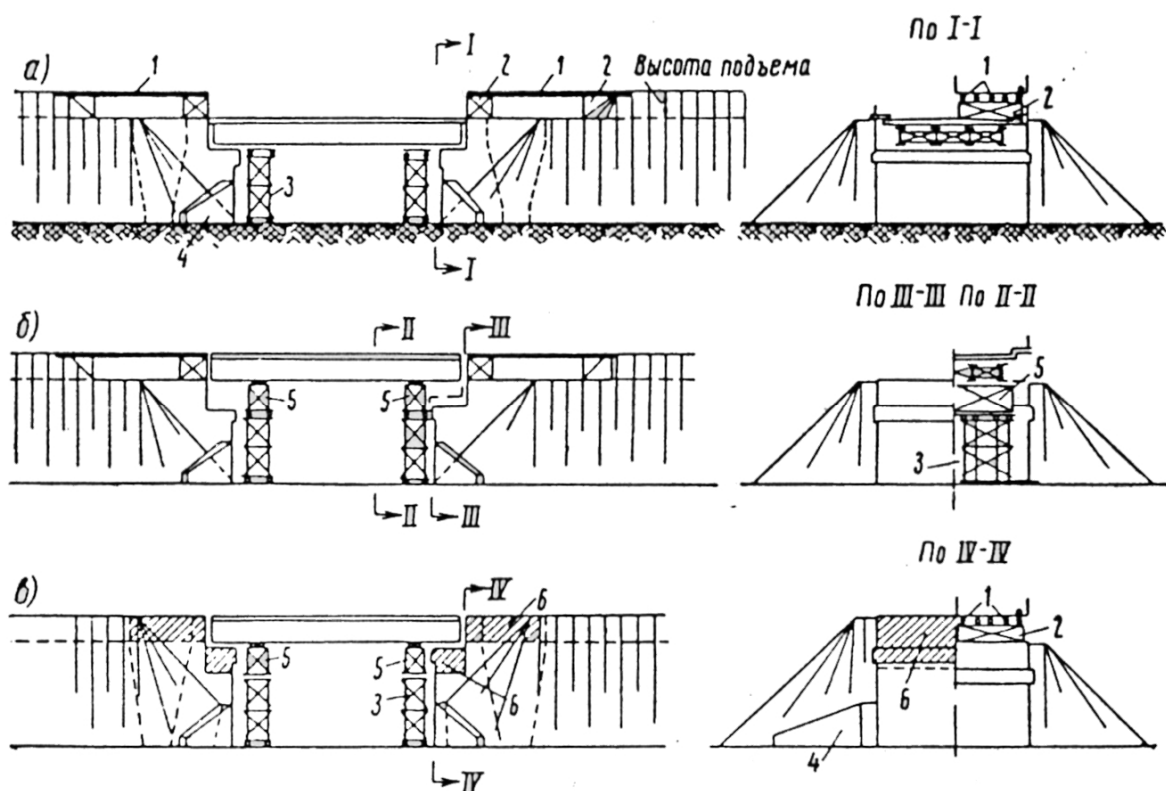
Схема подъёмки моста малого отверстия: а – первая стадия; б – вторая стадия; в – третья стадия; 1 – временные пакеты; 2 – шпальные клетки; 3 – временные опоры; 4 – откосная стенка; 5 – клетки для подъёма пролетного строения; 6 – новая кладка
